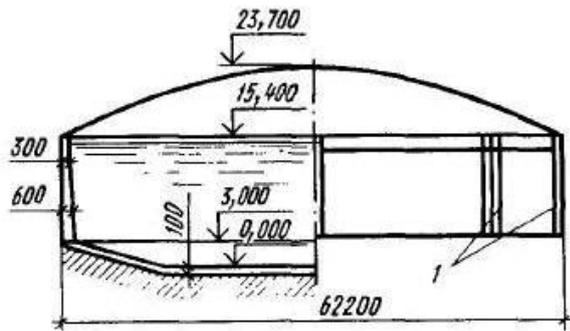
Предварительно напряженный резервуар (фрагменты разреза и фронтального вида):
